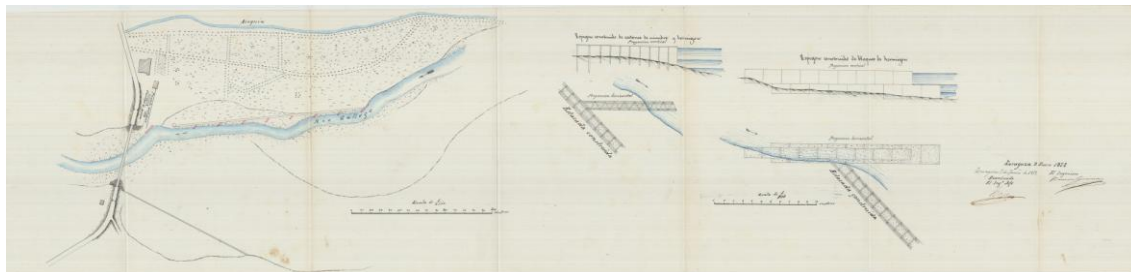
Plano topográfico con el proyecto de unos espigones para la defensa de las estacadas de la margen derecha del río Gállego junto al puente colgante de Santa Isabel. Zaragoza, 9 enero 1872.
